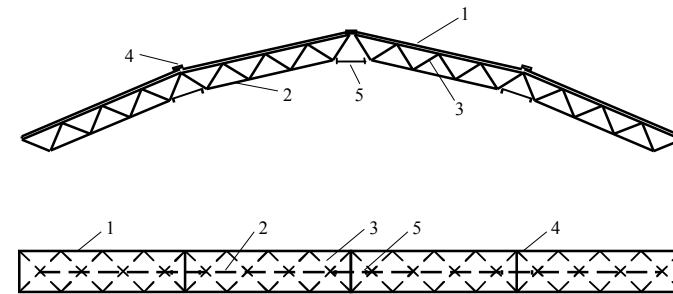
Склепіння з лінійних сталезалізобетонних структурних елементів: 1 – залізобетонна плита; 2 – нижній пояс; 3 – розкоси; 4 – закладні деталі для з'єднання плит; 5 – додаткові стрижні для з'єднання нижнього пояса
